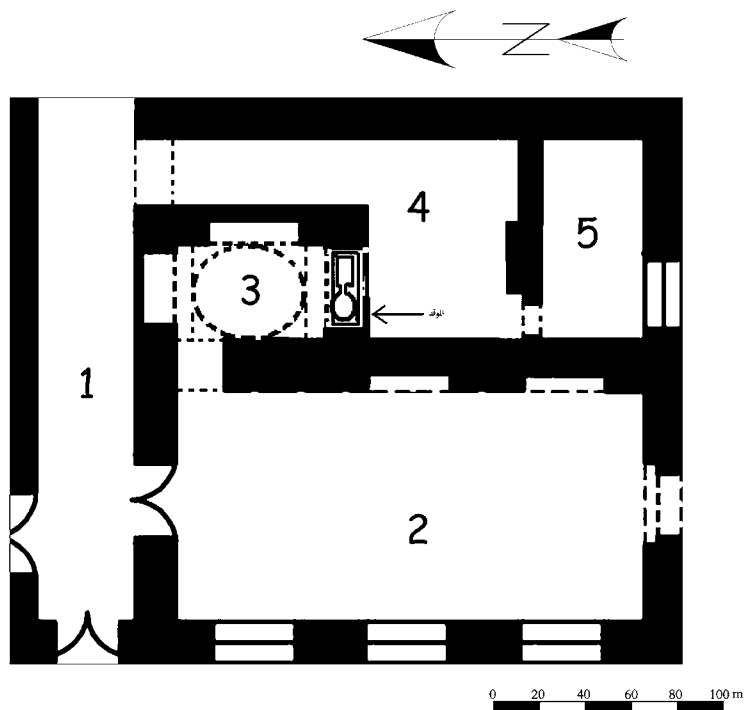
قصر بن سليمان بجبره: مسقط أفقي للطابق الأول. (عمل بمعرفة الباحث).
